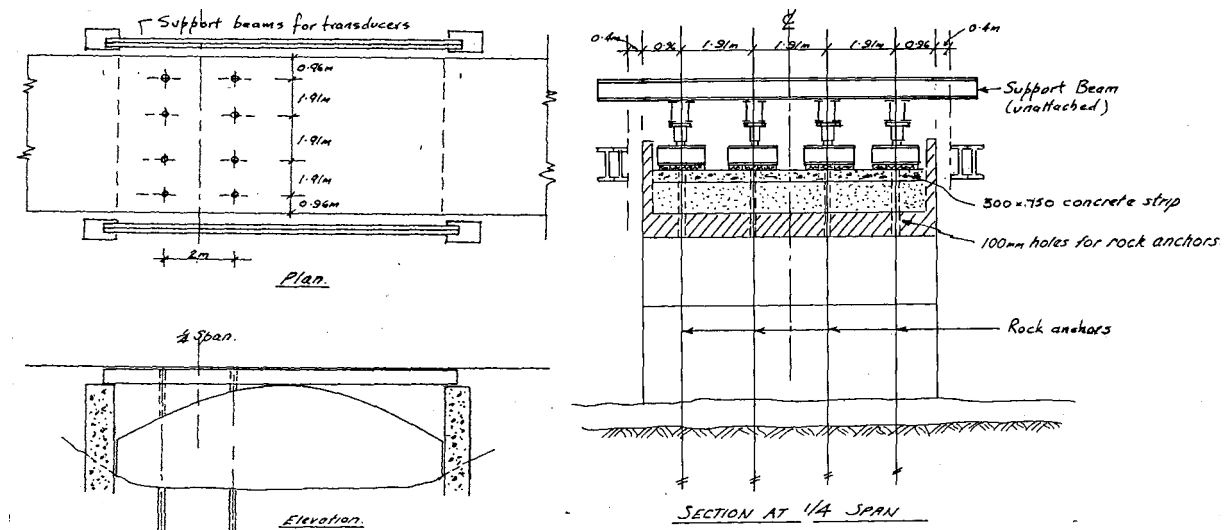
Esquema de aplicação da carga na ponte de Bridgemill ^{Hendry et al, 1985}.
